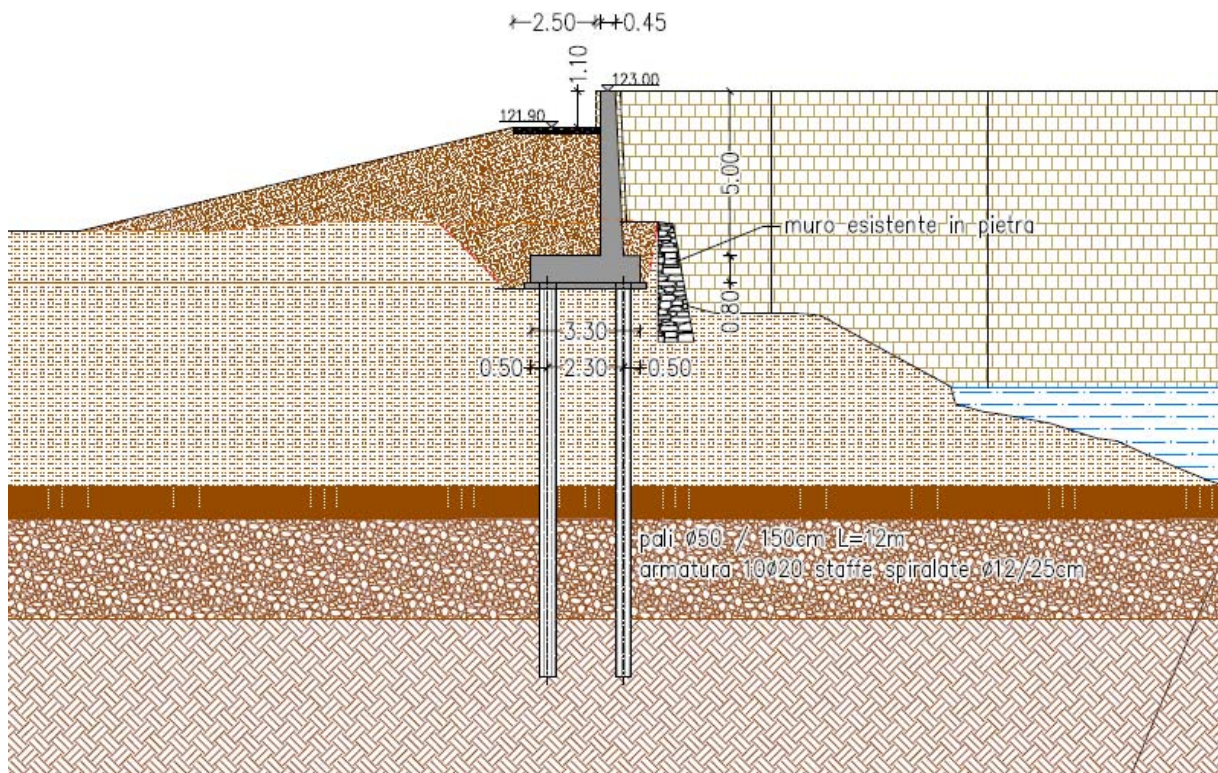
Sezione tipo muro d'argine zona campi sportivi a Incisa (parte centrale)
